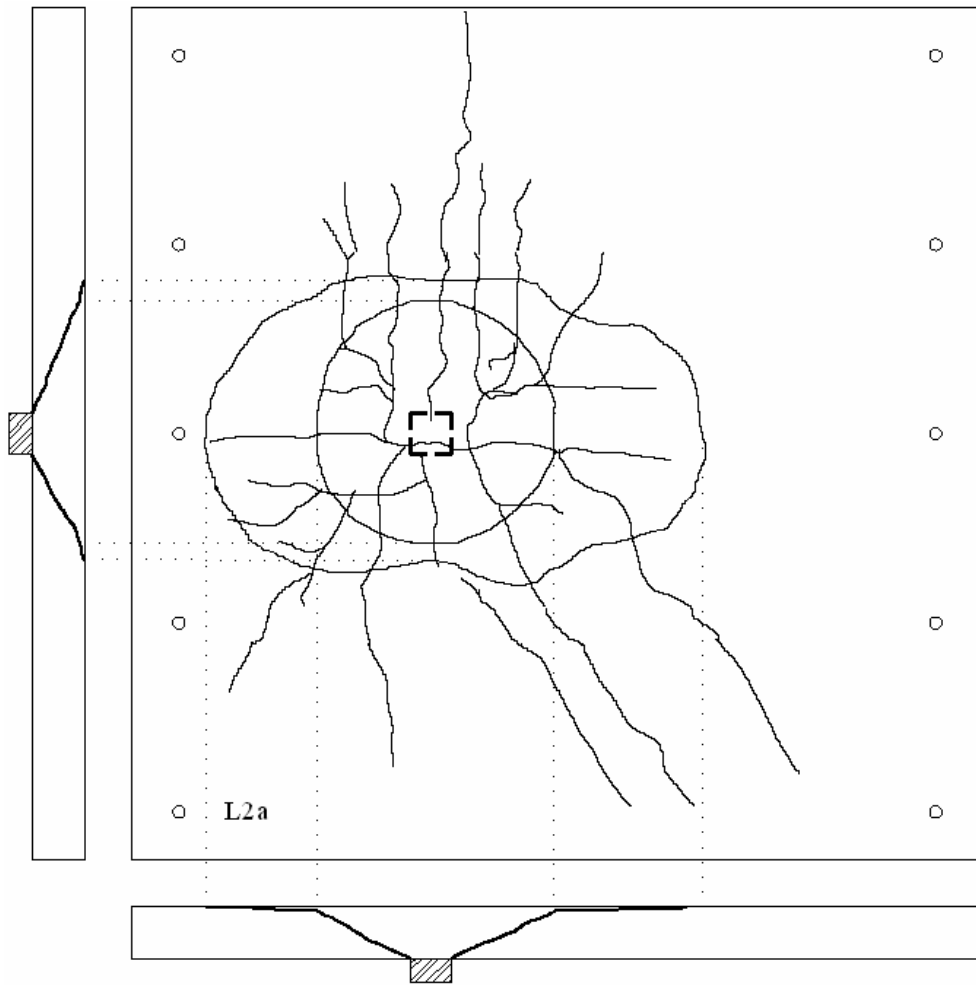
Mapa de fissuração da laje L2a
